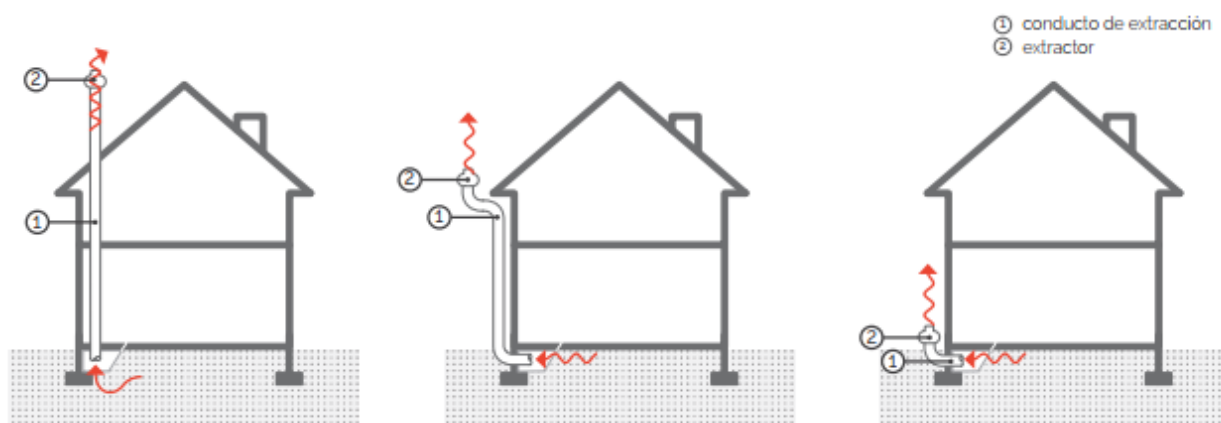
Conducto de extracción a cubierta por el interior del edificio (izquierda) y por el exterior (centro) y a fachada (derecha). Fuente: Guía de Rehabilitación frente al radón.
